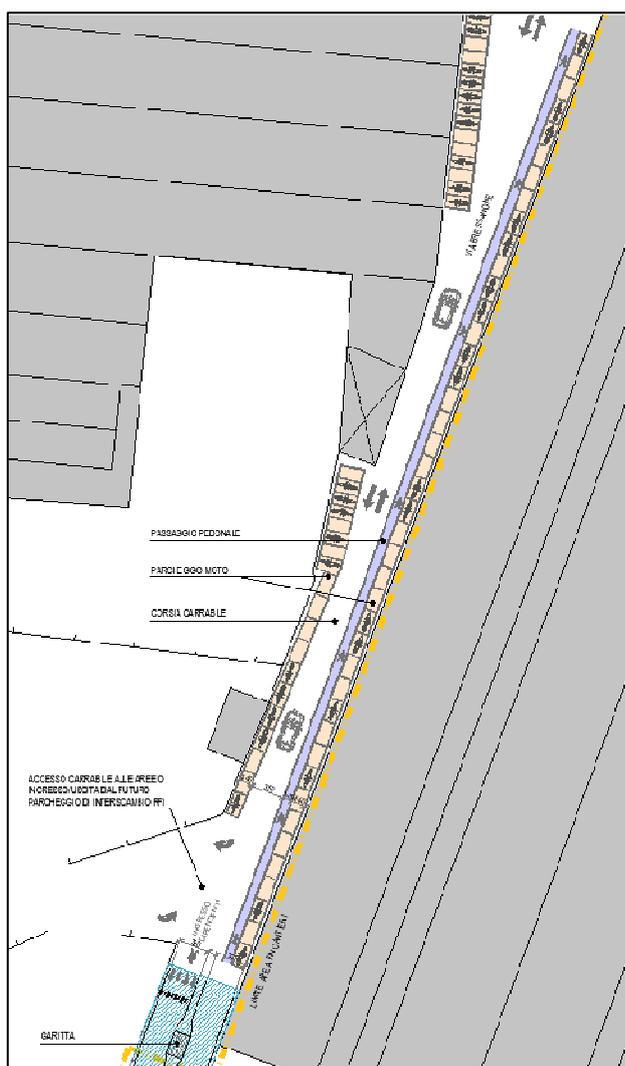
Nuovo parcheggio moto su Via Bressanone
